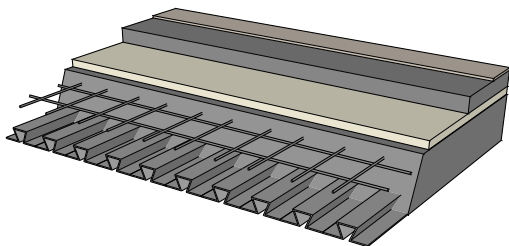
Konstruktionsschema Trapezblechverbunddecke
